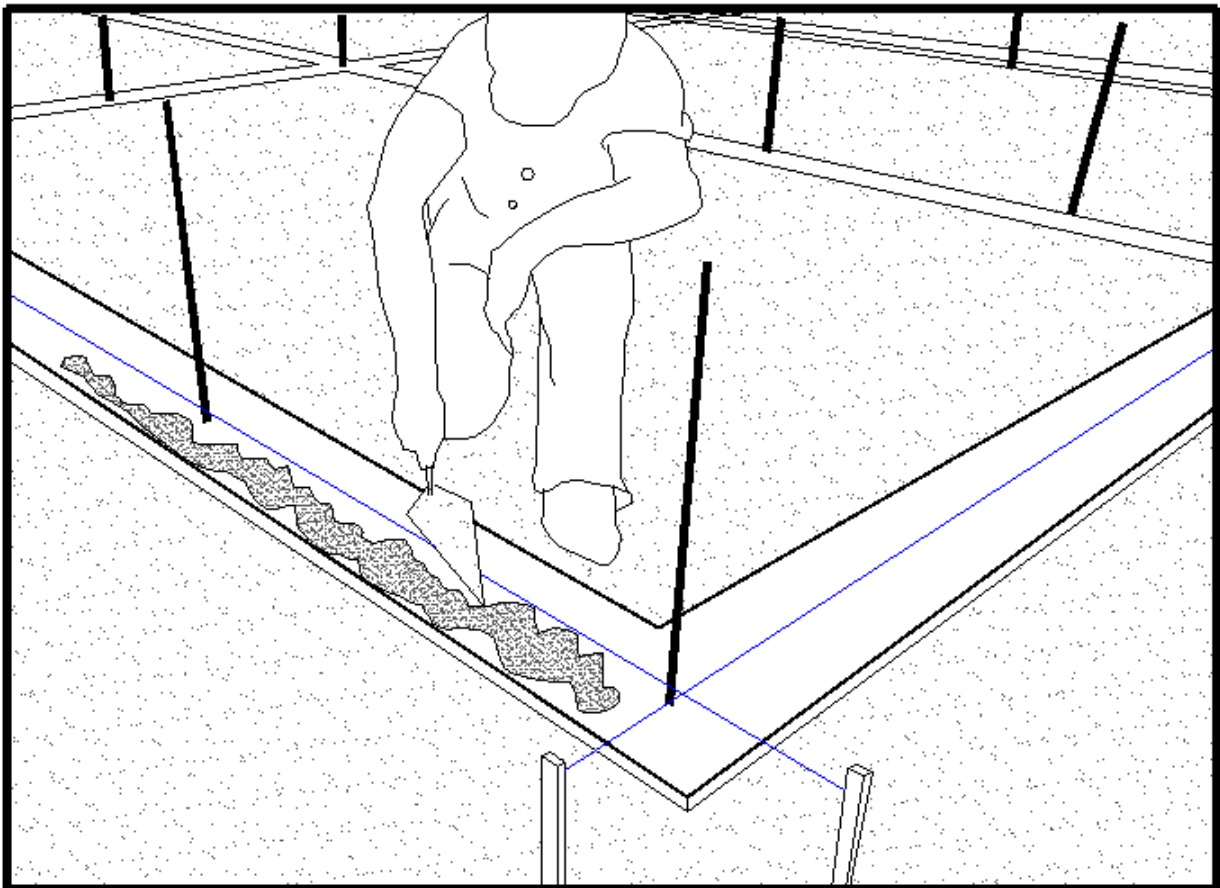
Marcado de ejes y colocación de mortero de junta.
